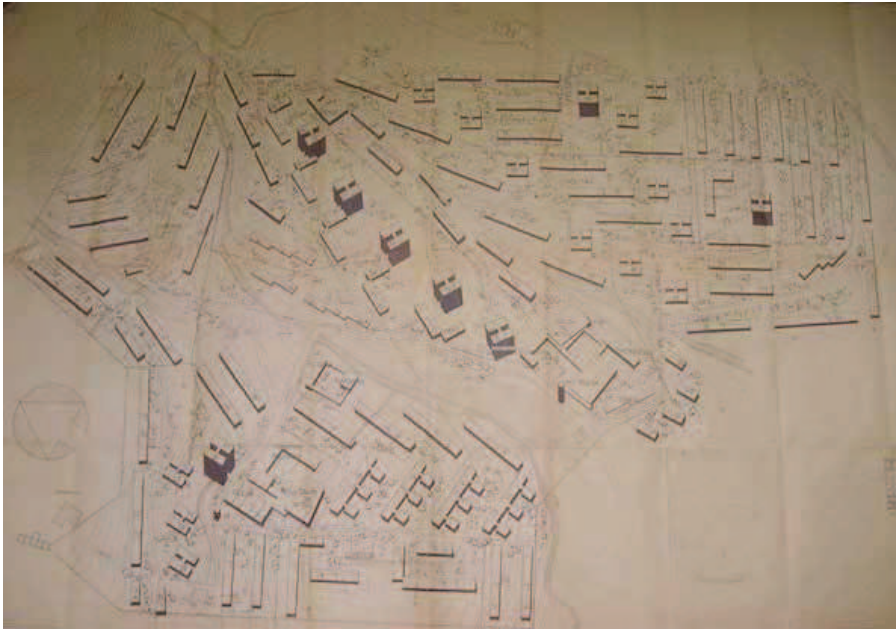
Plano proyecto Polígono Otxarkoaga Ministerio de la Vivienda.
